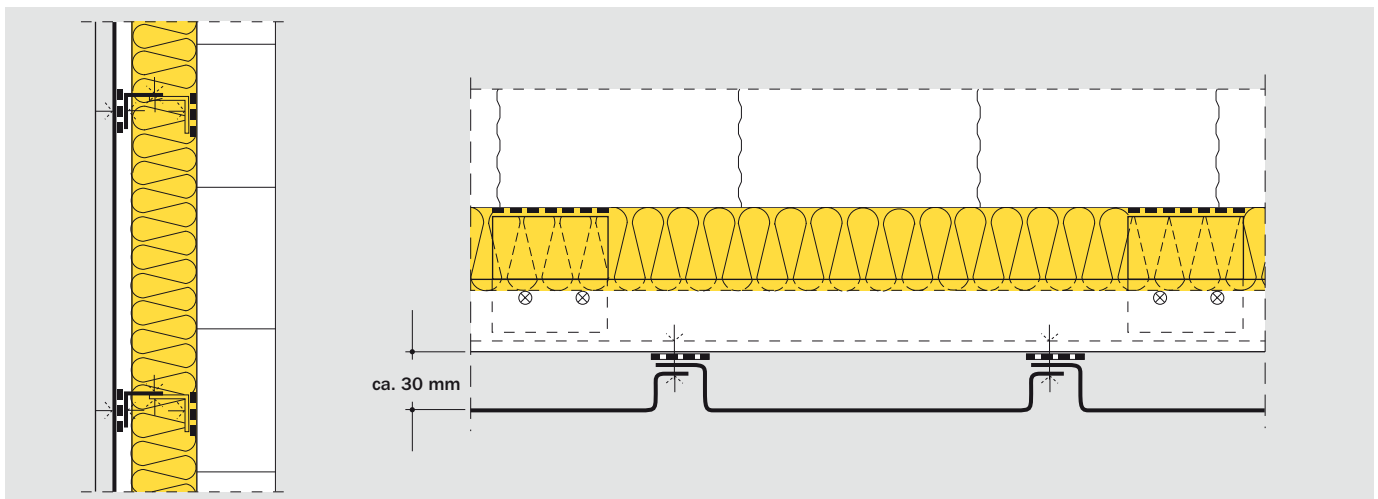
Aluminium-Kassetten mit Nietbefestigung
